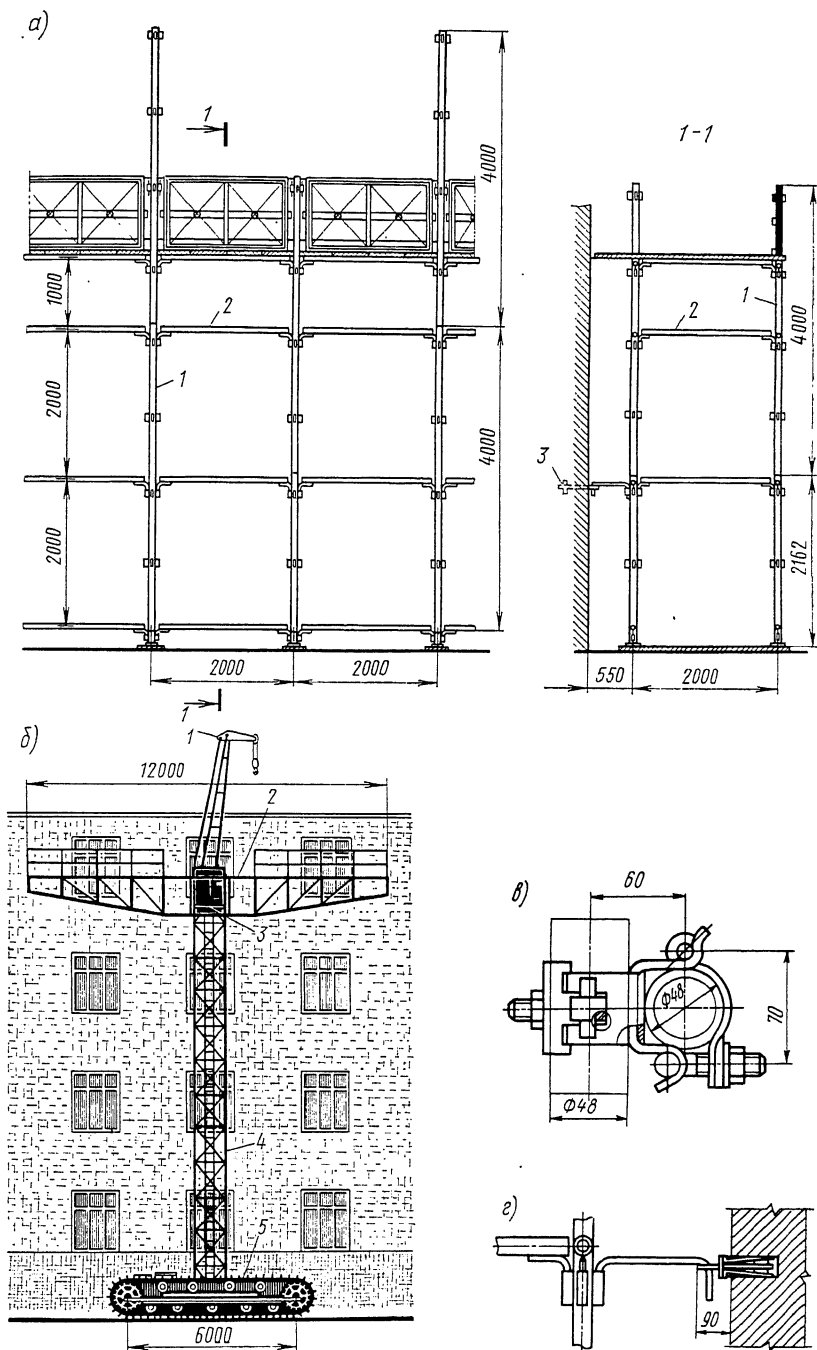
Леса для наружных штукатурных и отделочных работ
